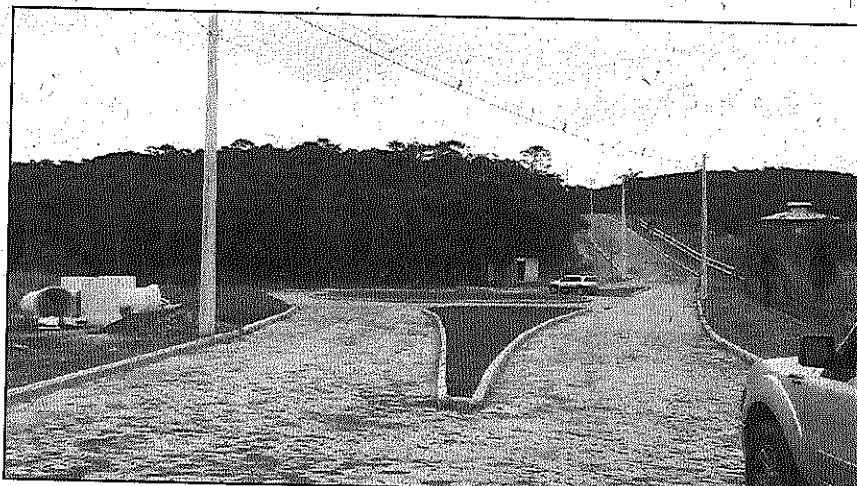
Detalhe da seção das ruas, Projeto de Pavimentação.
